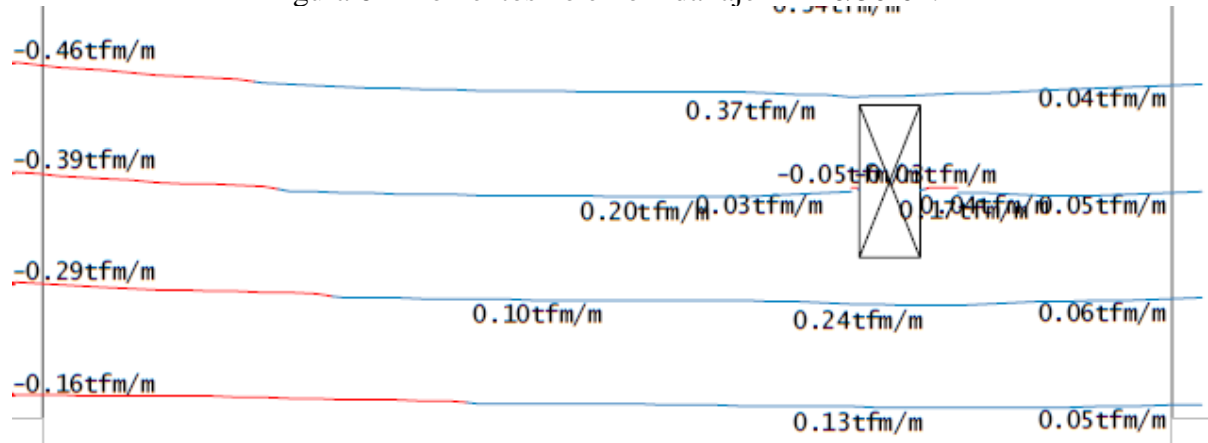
Armaduras negativas horizontais e verticais para a laje LA 20/50-02.
